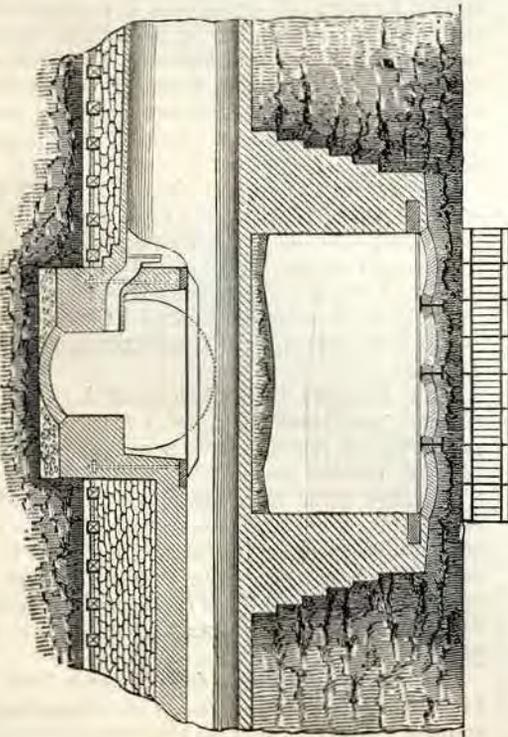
Passaggio dell'emissario sotto il torrente Maelbeck con viadotto
